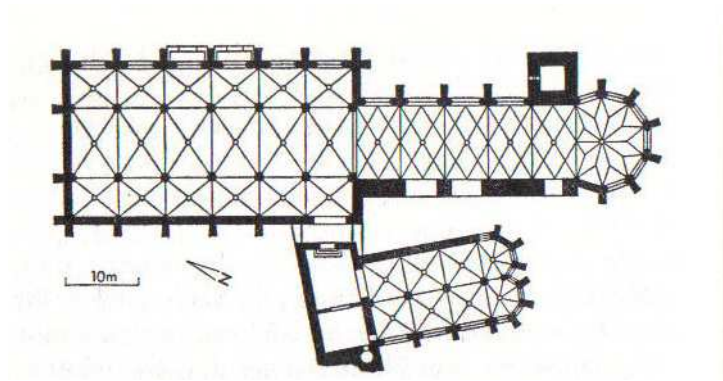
Grundriss der Augustinerkirche mit Georgskapelle
